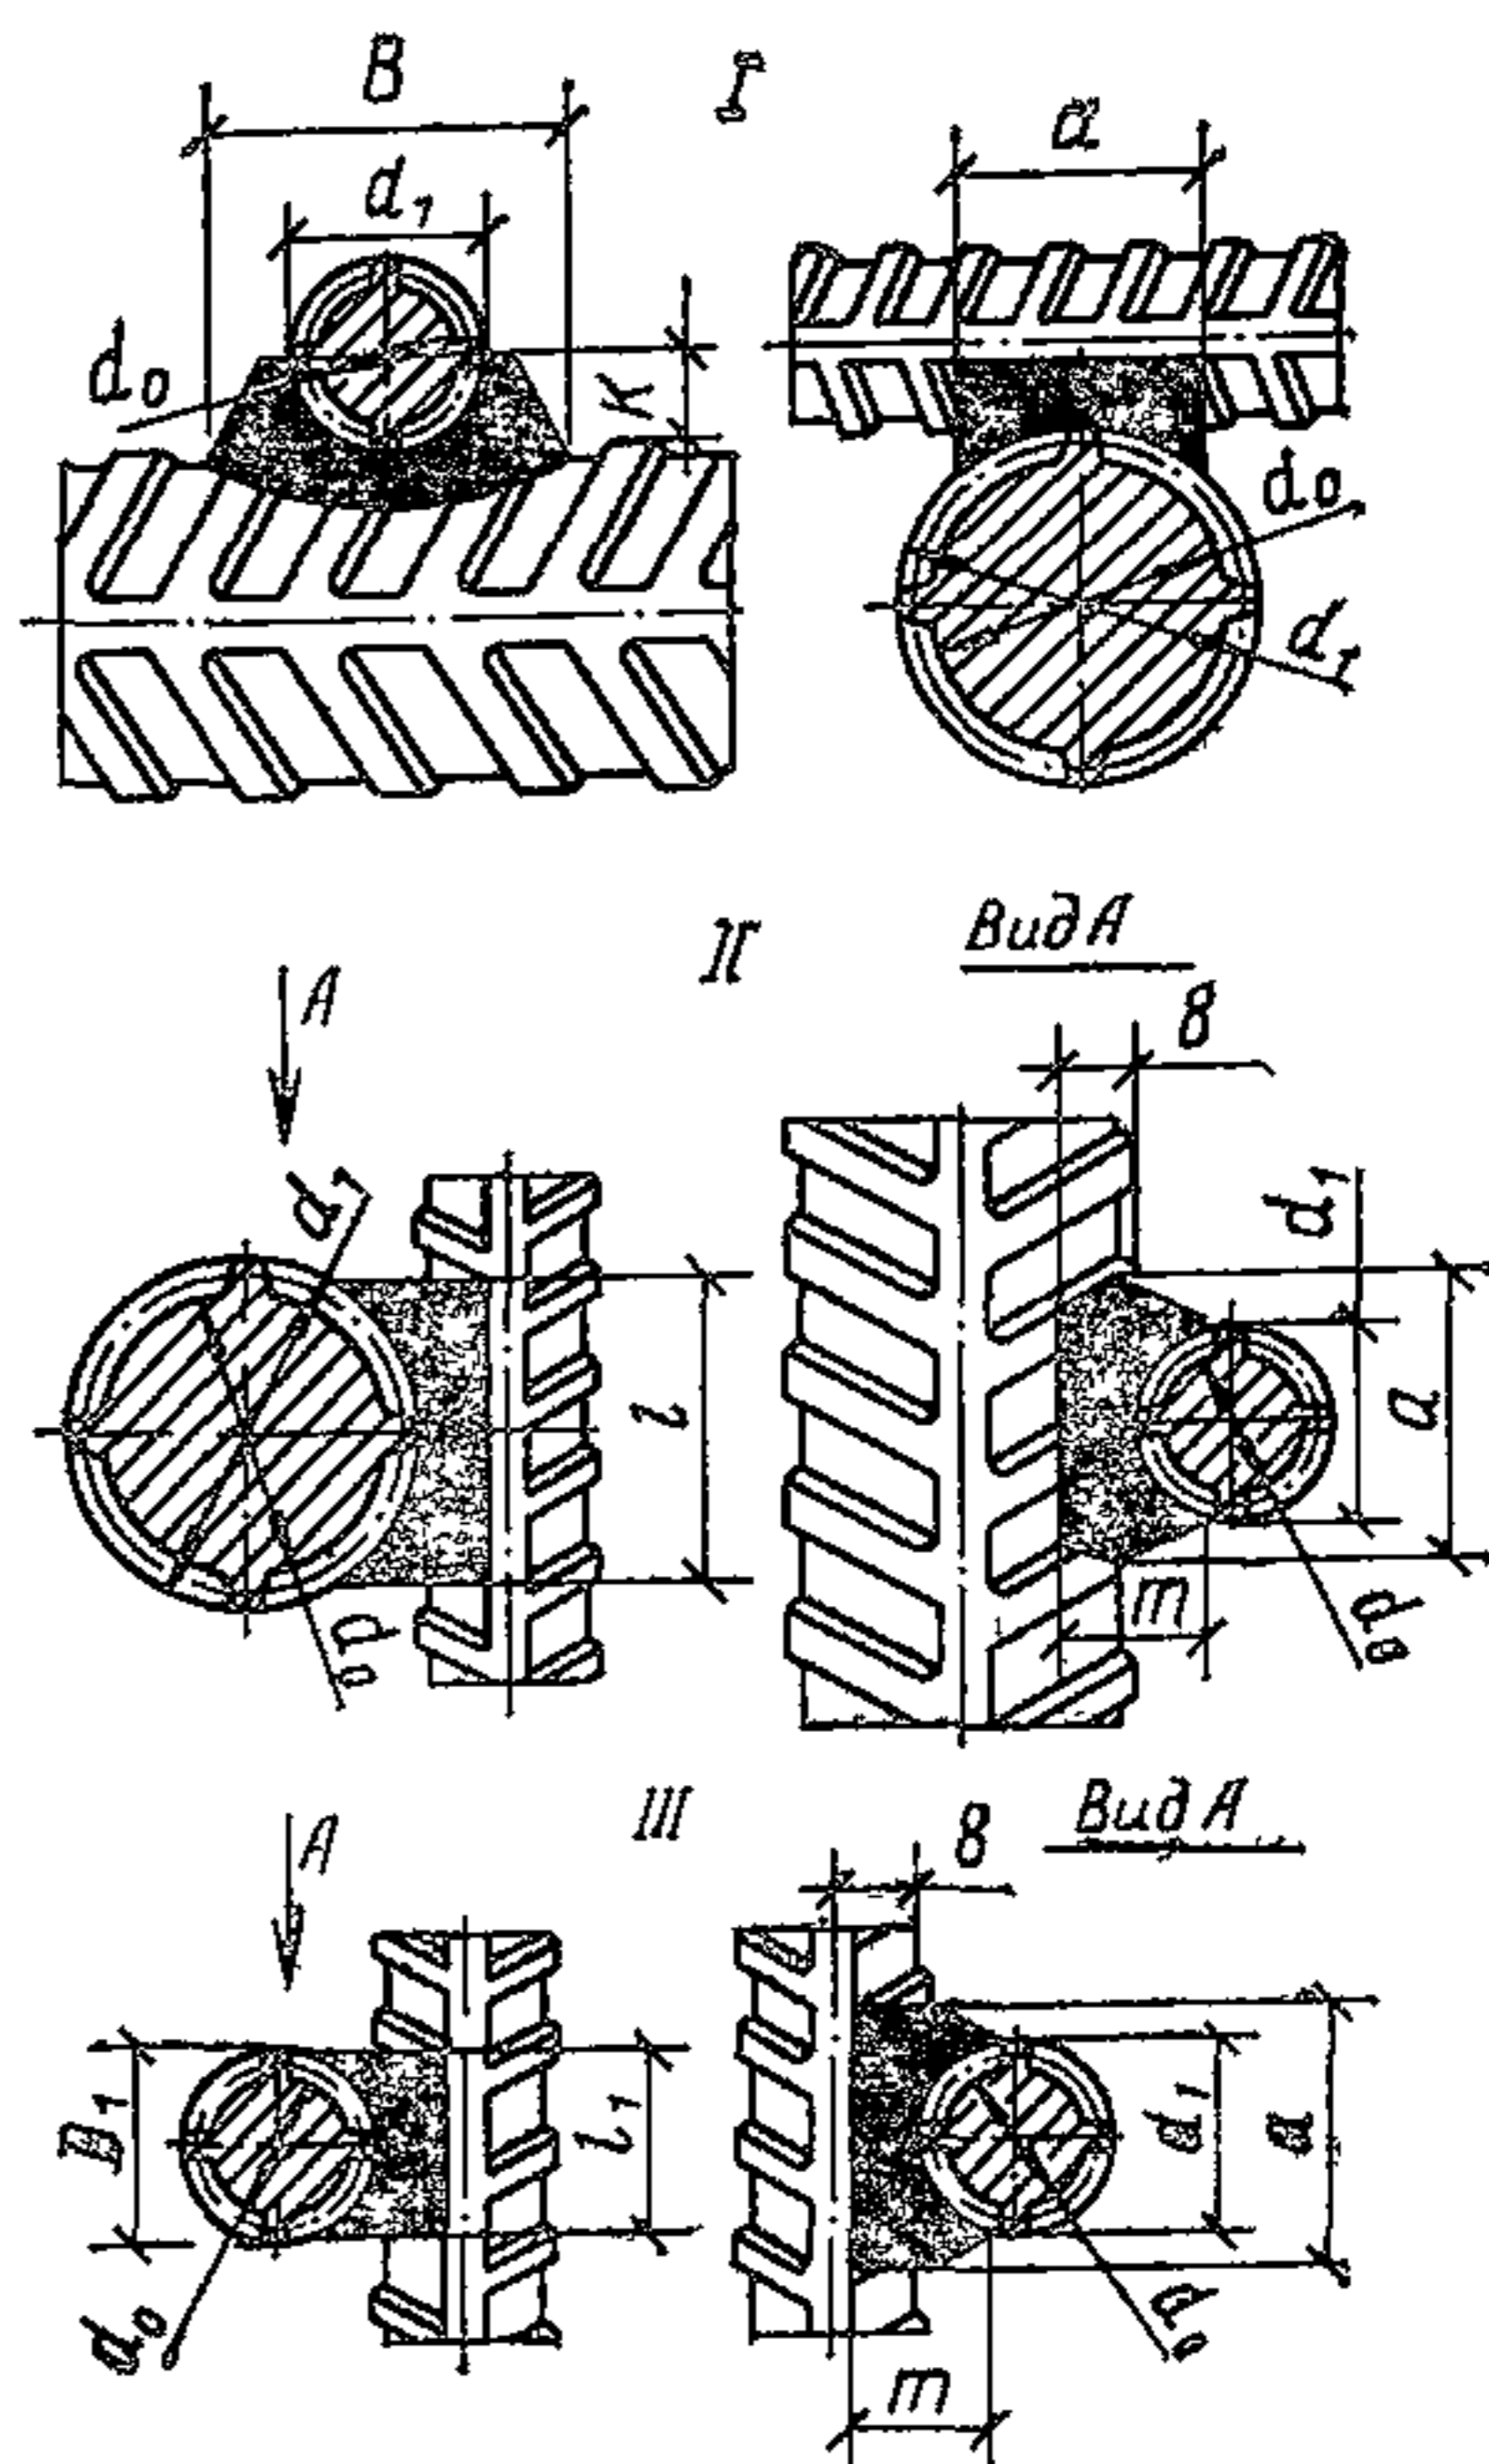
Схема расположения прихваток при сборке изделий с крестовыми соединениями стержней
